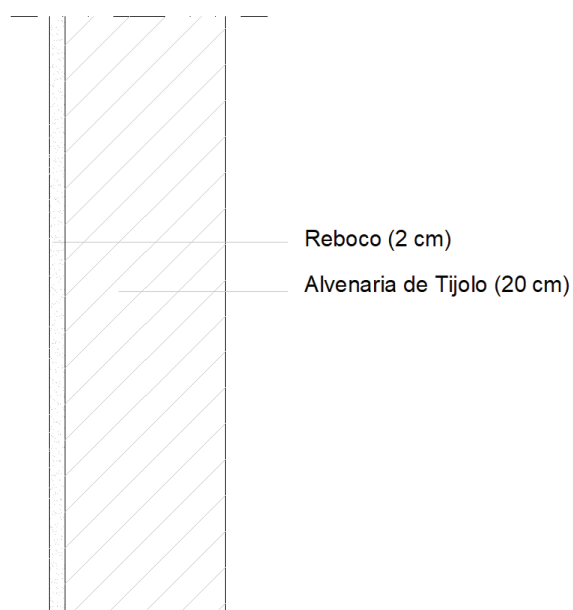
Pormenor construtivo da parede interior tipo IX (reservatório de água)
